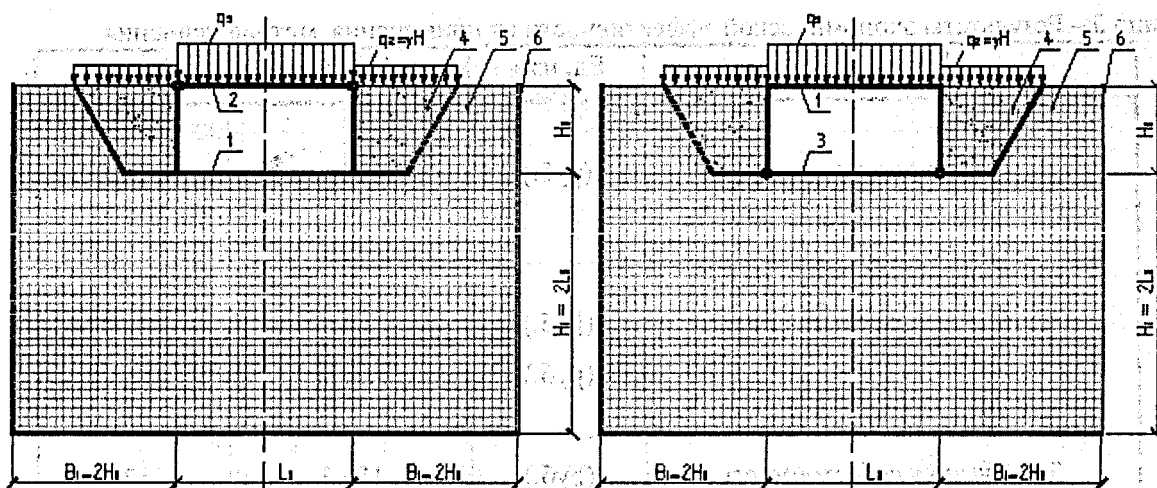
Расчетные модели подземных каналов из сборного железобетона
